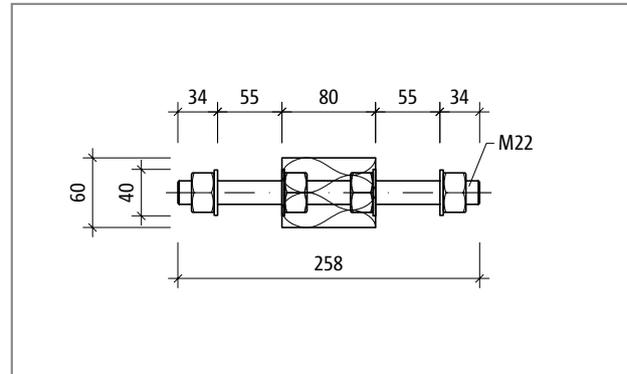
Schöck Isokorb® T type S-N-D22 : coupe du produit
